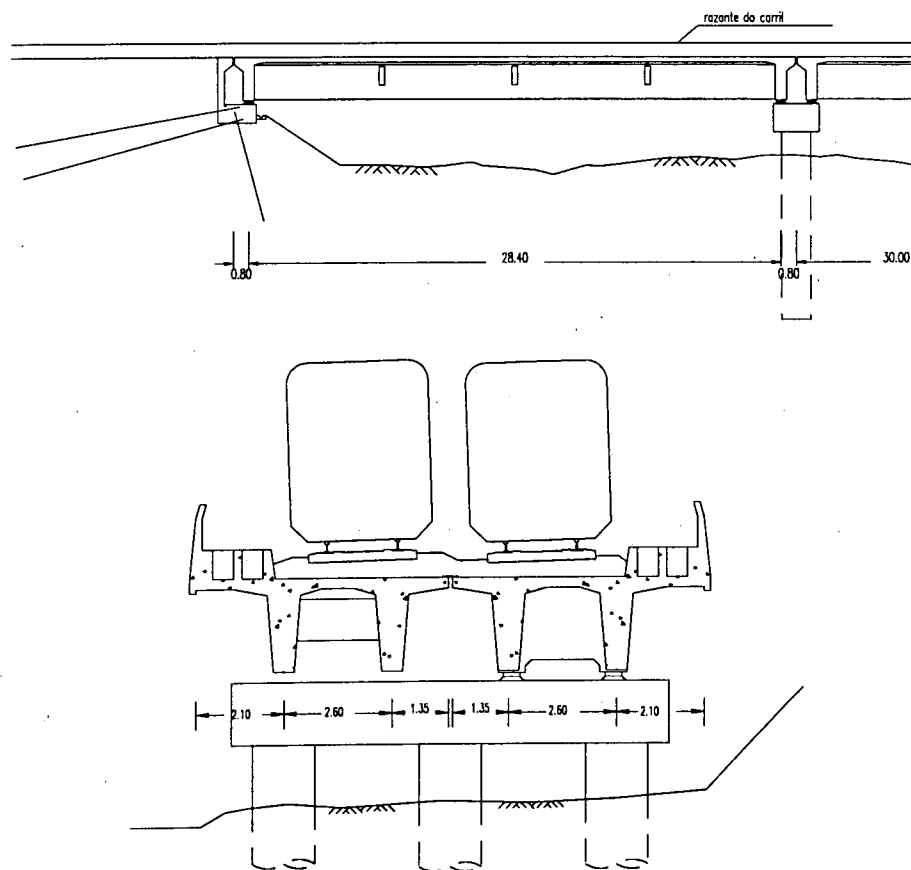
Cortes longitudinal e transversal do viaduto
